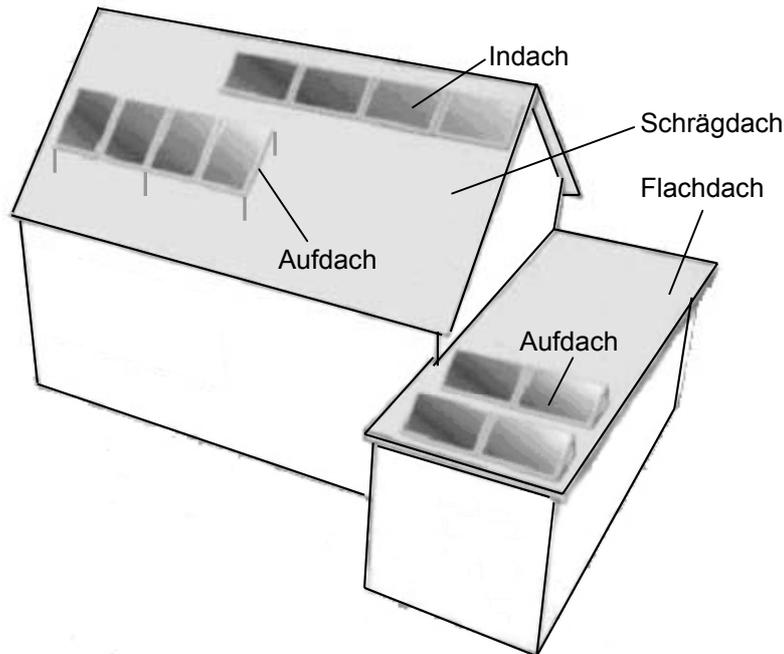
Montagearten von PV-Systemen an Gebäuden, nach [WÖR04]
